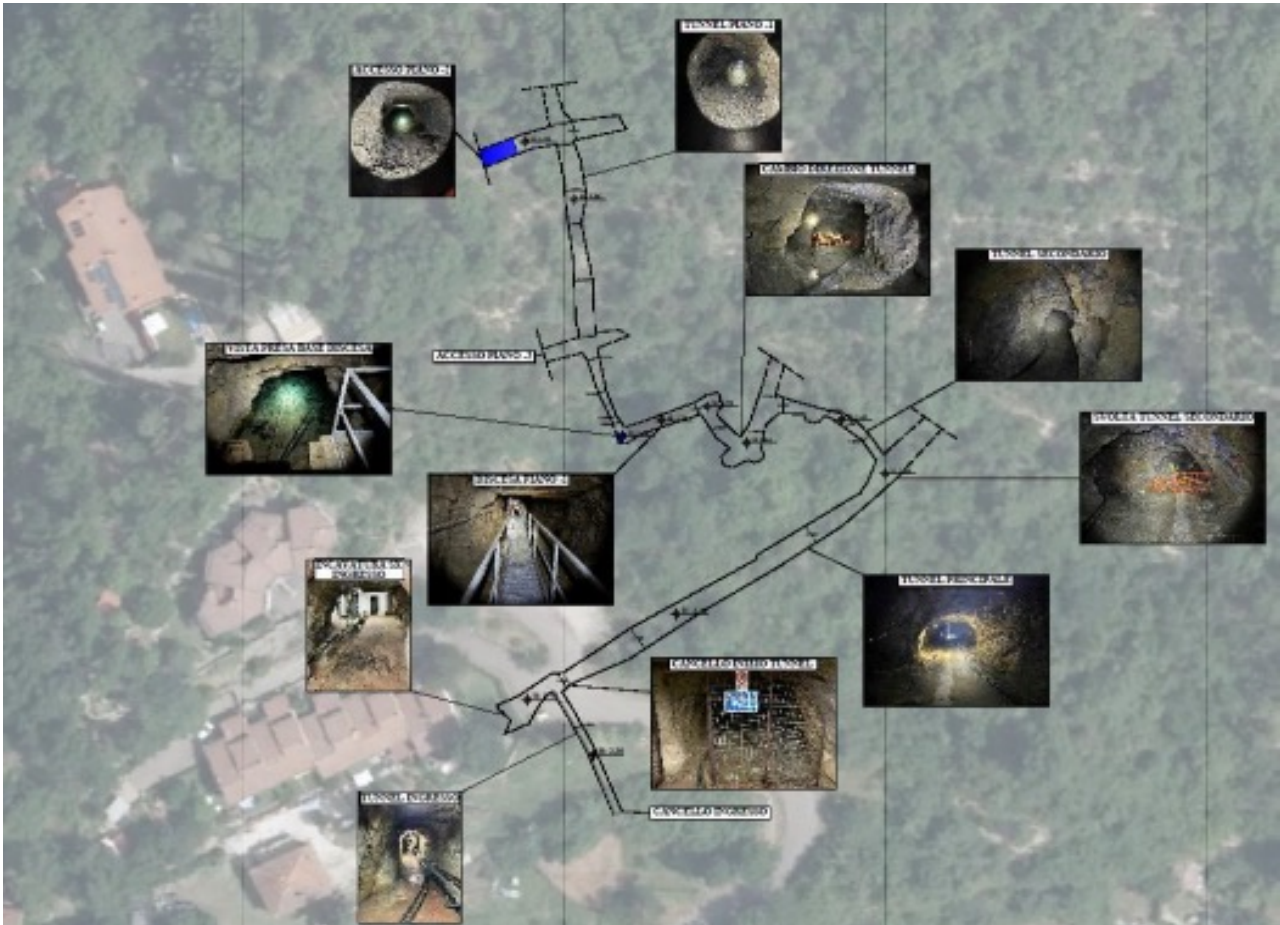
Sviluppo del percorso planimetrico dei tunnel di miniera
